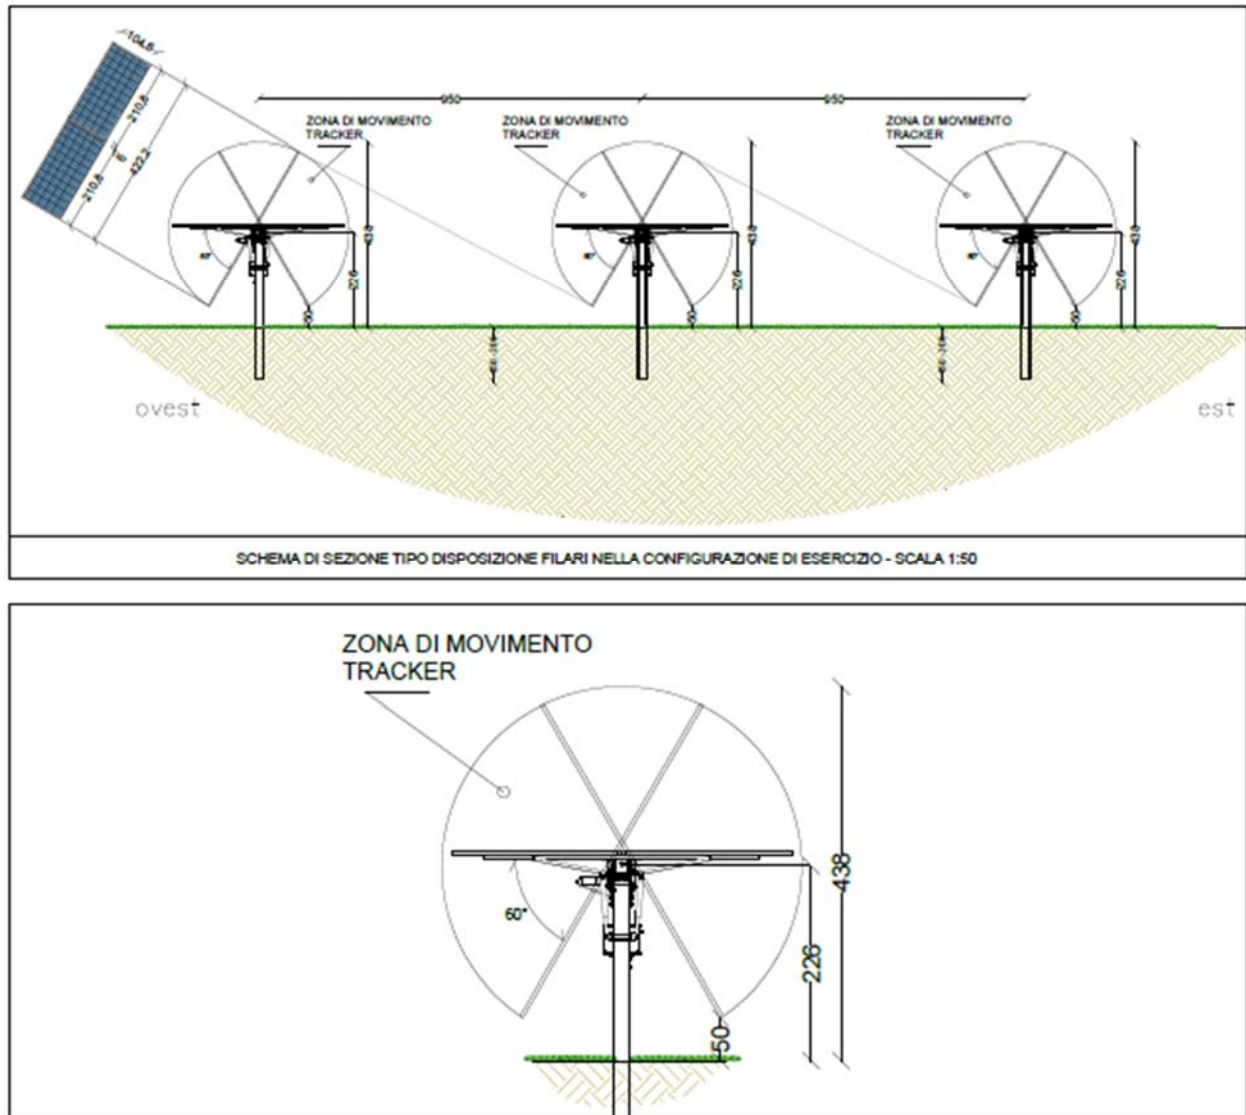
Estratto elaborato A.12.b.2.a_Sezioni tipo impianto
